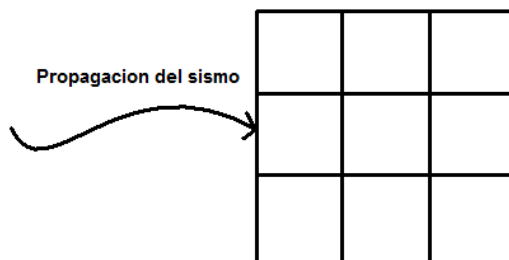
Entrada del sismo en la vista de planta del edificio
